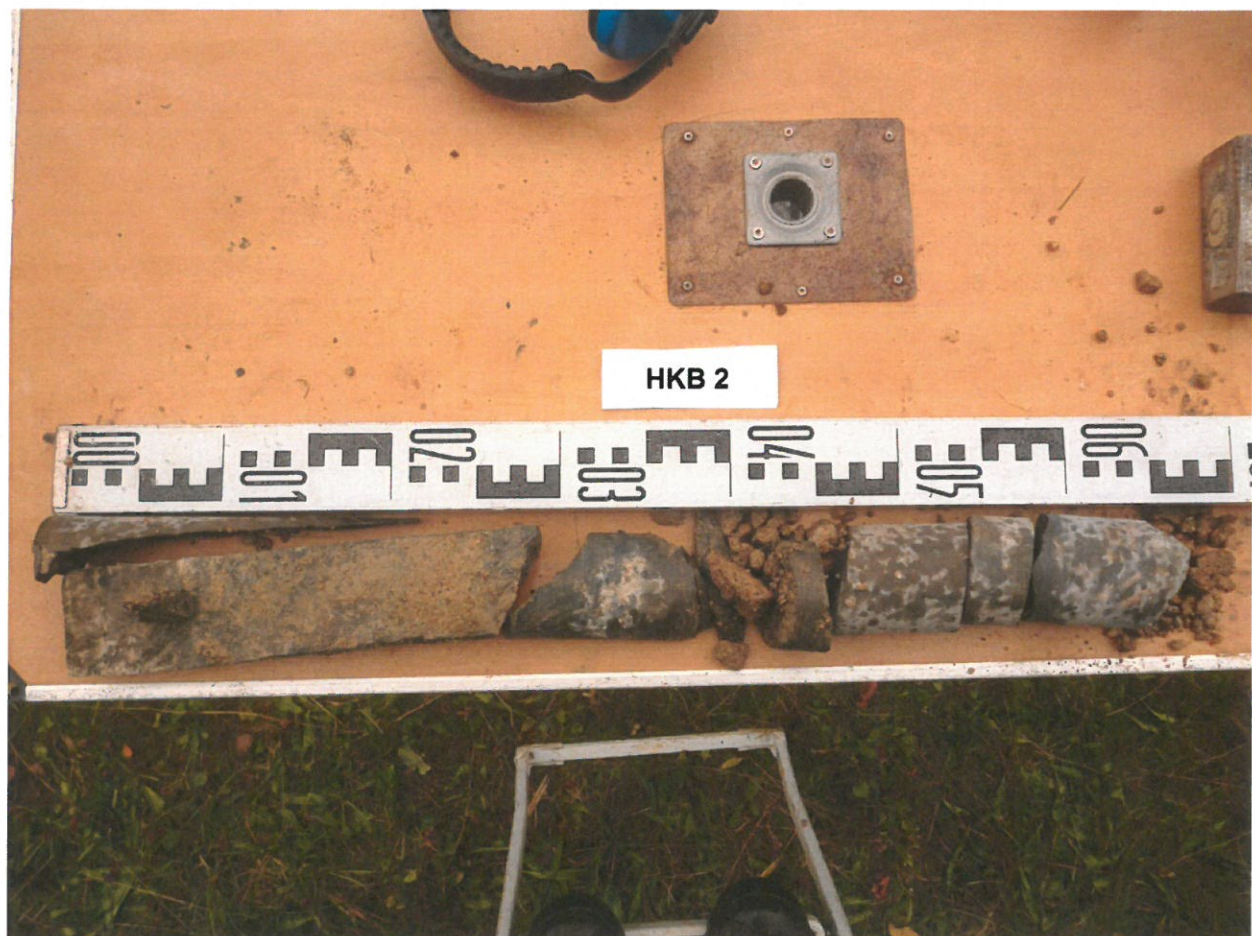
Horizontalkernbohrung HKB2, Schnitt 2-2
